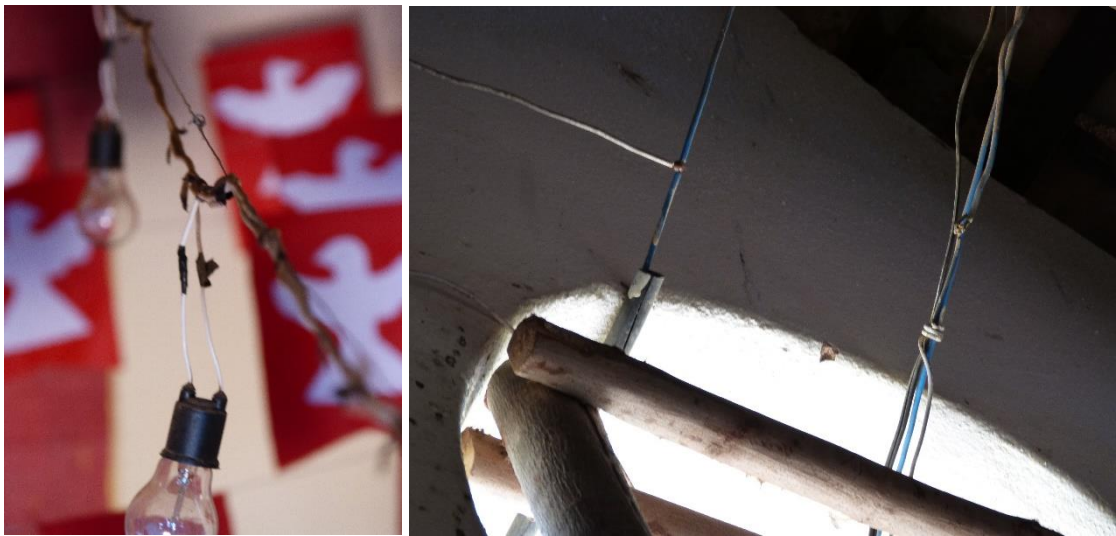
Detalhes da instalação elétrica executada na nave – isolamento das emendas nos fios.
